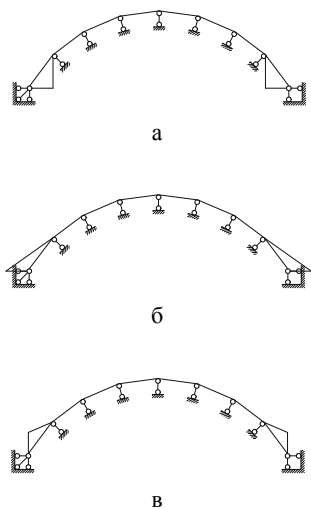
Можливі схеми підкріплення покриття опорними фермами
